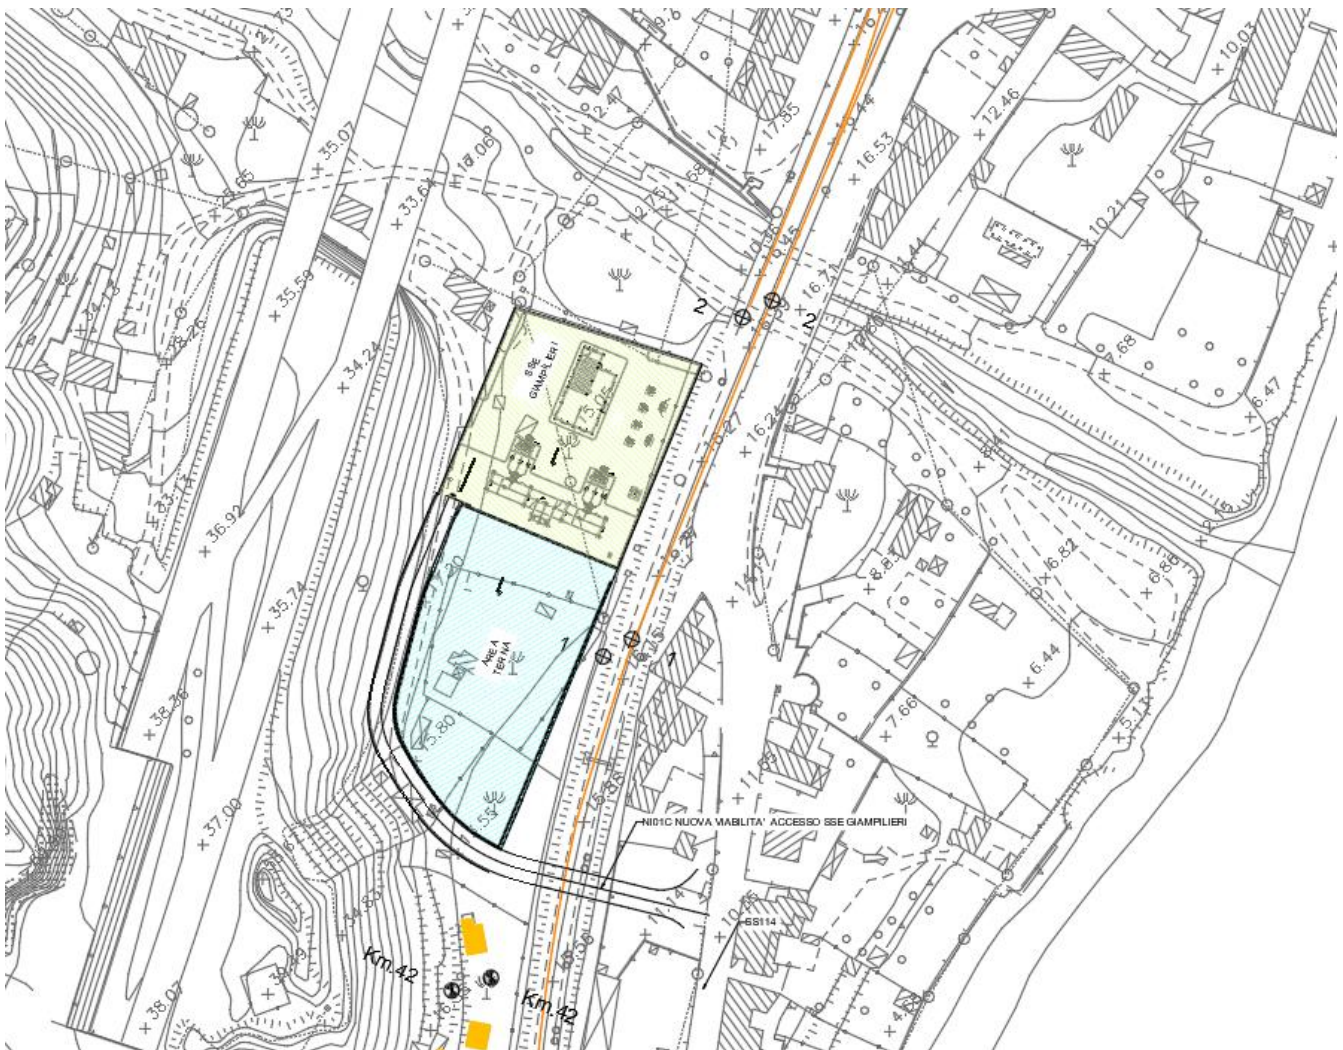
Stralcio planimetria SSE Giampilieri (MS)
